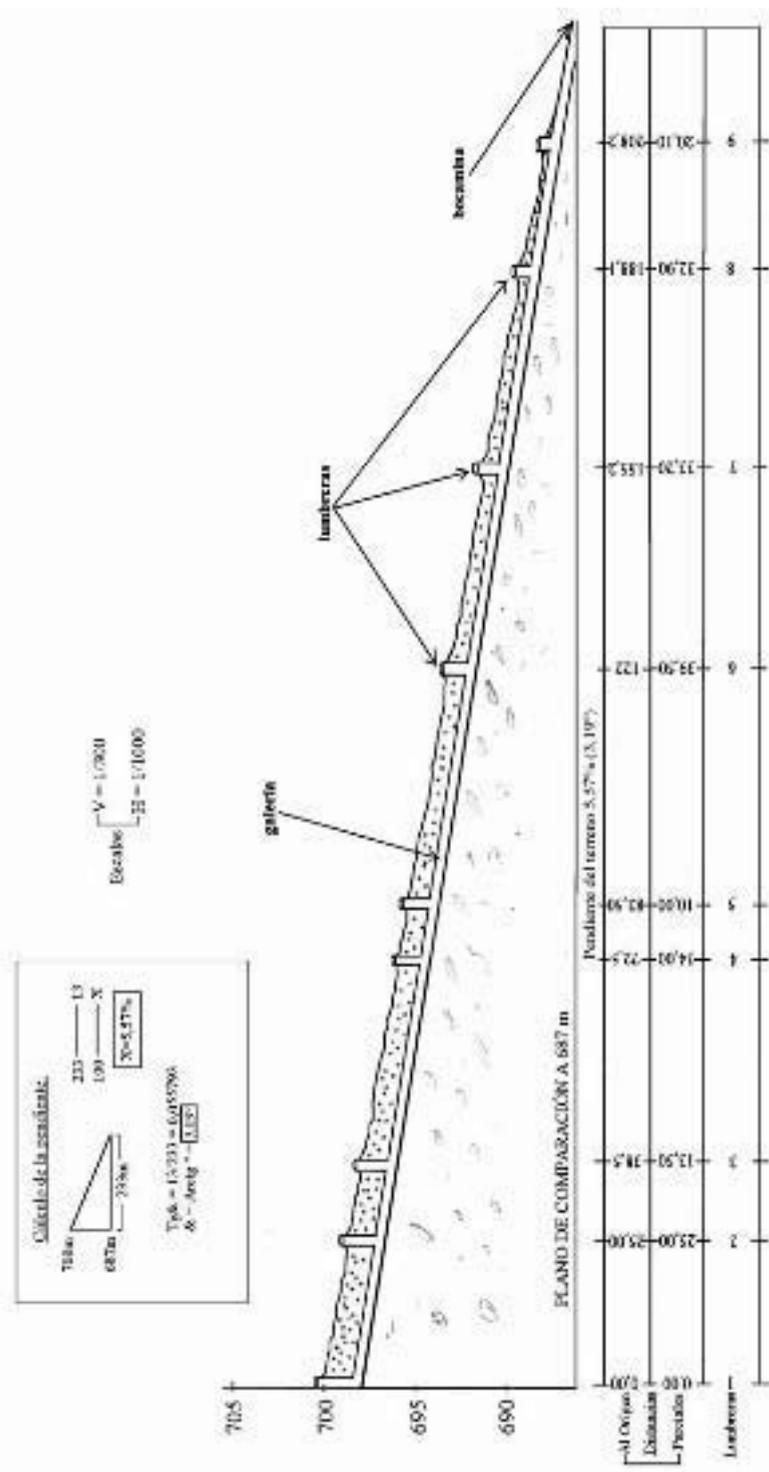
Perfil longitudinal del sistema de la galería con lumberas de El Pulpillo.
